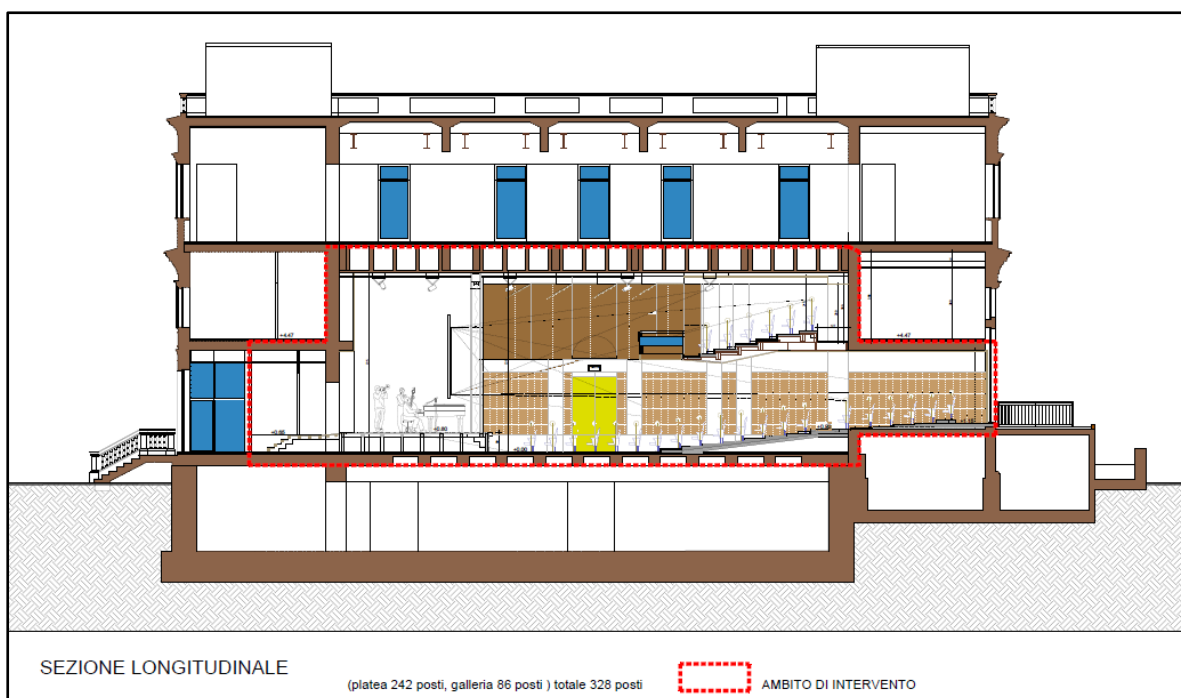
Progetto preliminare, oggetto di convenzione, per il recupero del Kursaal
